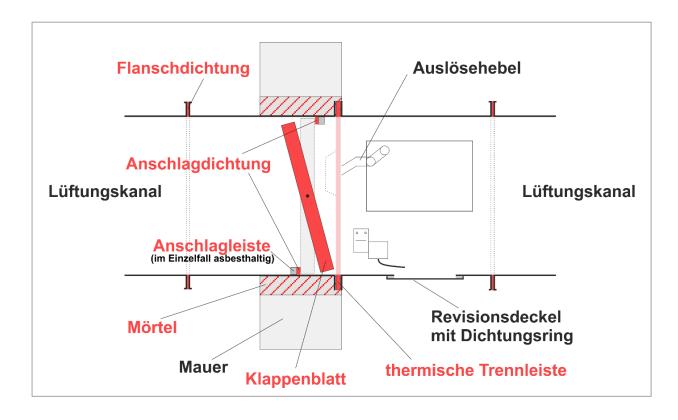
Schnitt einer eingebauten Brandschutzklappe, schematisch (rot = Bauteile der BSK mit Asbestverdacht)
